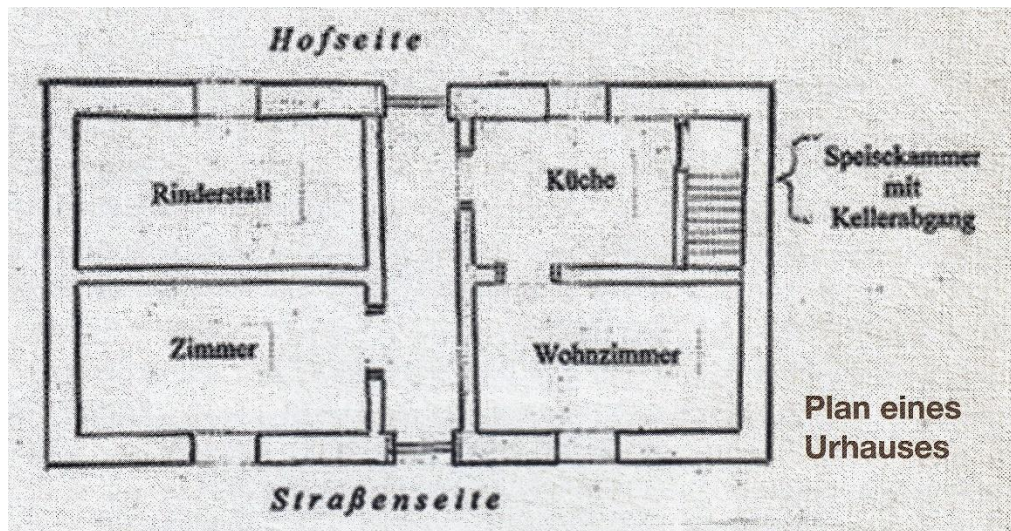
Theresienfeld, Grundriss eines Urhauses.
